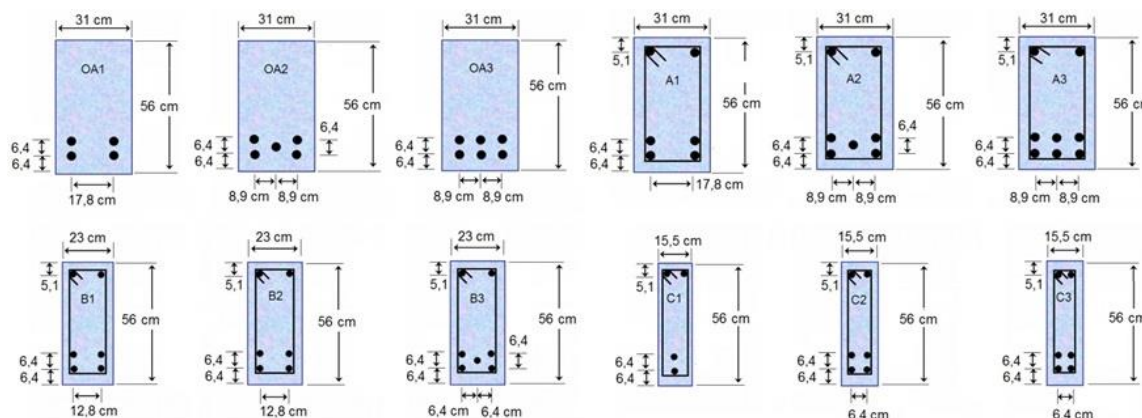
detalhes das seções transversais das vigas de Bresler & Scordelis (1963).
